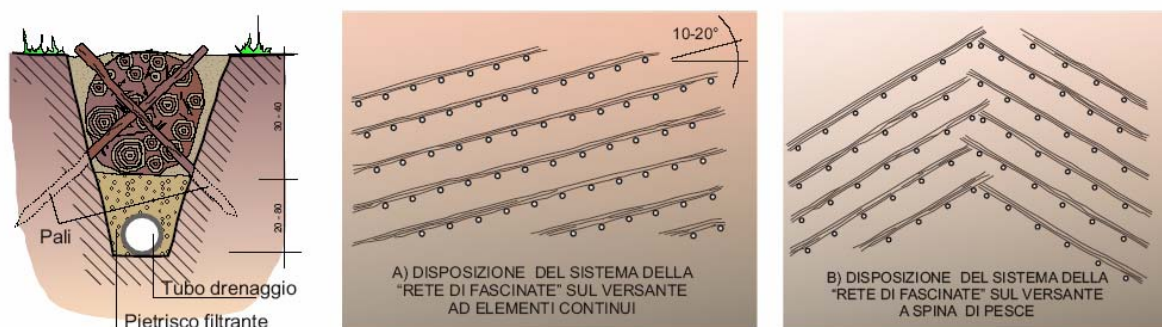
Utilizzo delle fascinate come sistemi di drenaggio superficiale. A sinistra sezione tipo di un sistema di drenaggio realizzato con fascine; al centro vista planimetrica di un sistema di fascinate disposte obliquamente rispetto alle curve di livello per evitare ristagni d'acqua; a destra vista planimetrica di un sistema di fascinate disposto a spina di pesce (da ANPA, 2002) -
